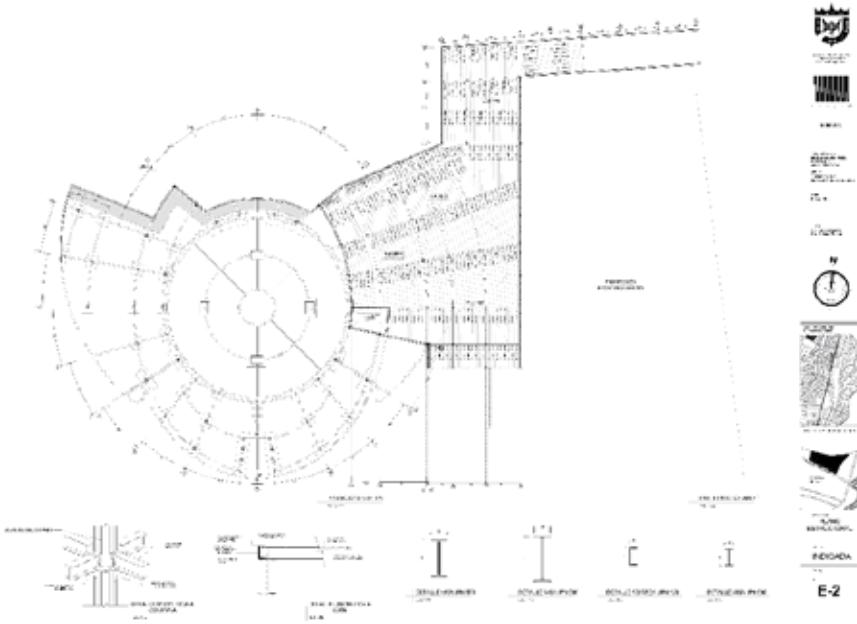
Estructura Losas de entresijos. Fuente: Autor (2021)
